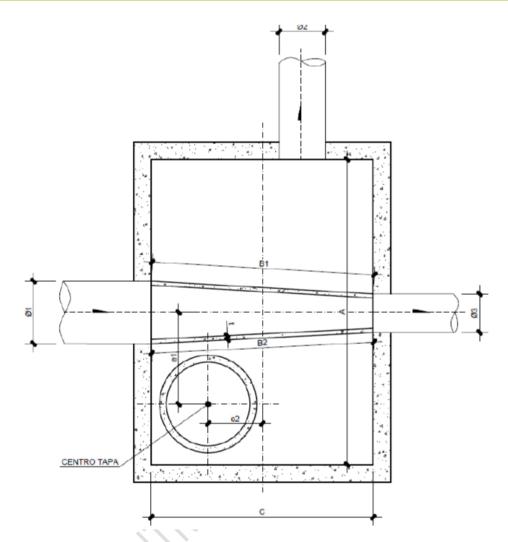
Vista en planta del aliviadero de cañuela elevada en caja.
